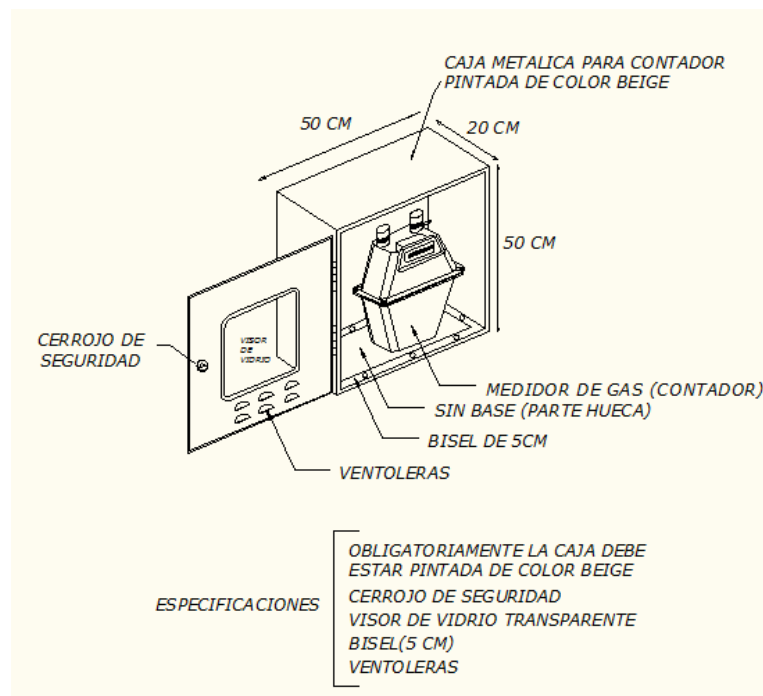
DIMENSIONES DE LA CAJA DEL CONTADOR
